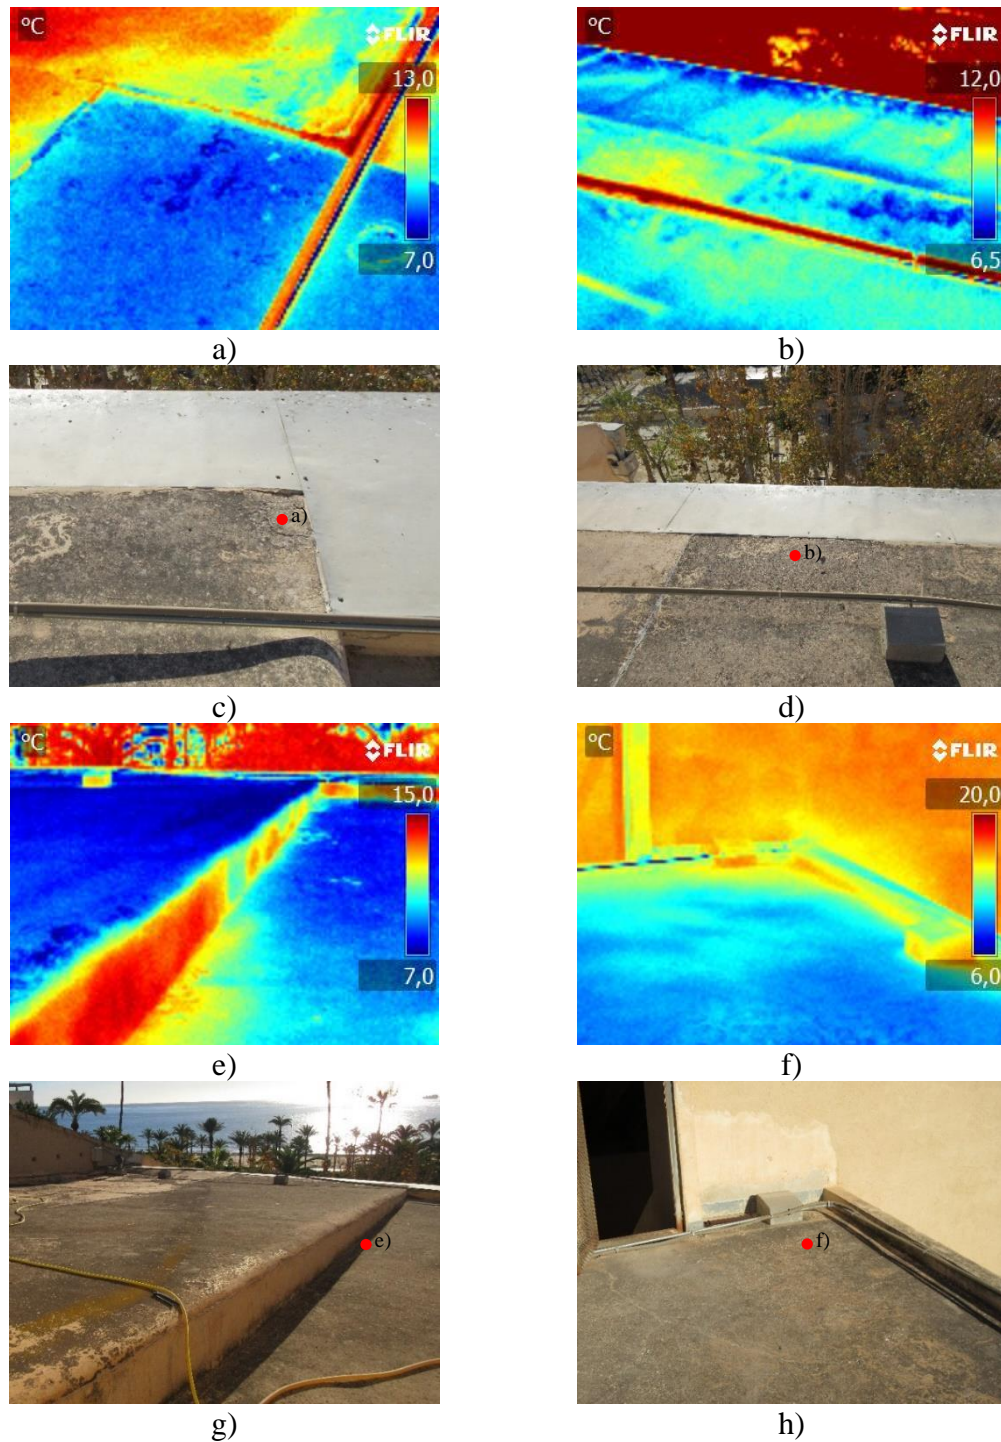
Termografía cubierta 2: a) Deterioro de junta perimetral, b) Detalle de fallo en junta perimetral en contacto del faldón con la fachada, c) y d) Imagen a) y b) con cámara digital, e) Detalle del extremo lateral del faldón y conexión con cubierta, f) Zona perimetral del faldón en zona de acceso a la cubierta; g) y h) Imagen e) y f) con cámara digital.
